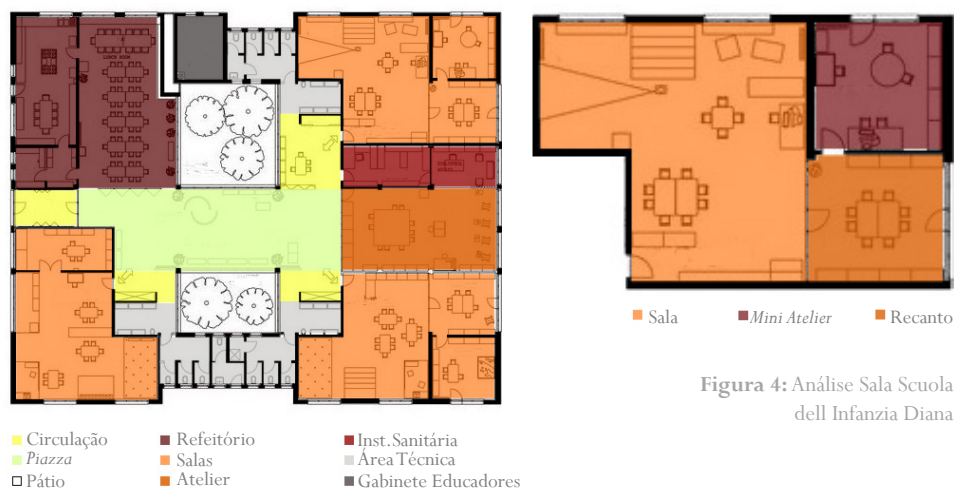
Análise Planta Scuola dell'Infanzia Diana
